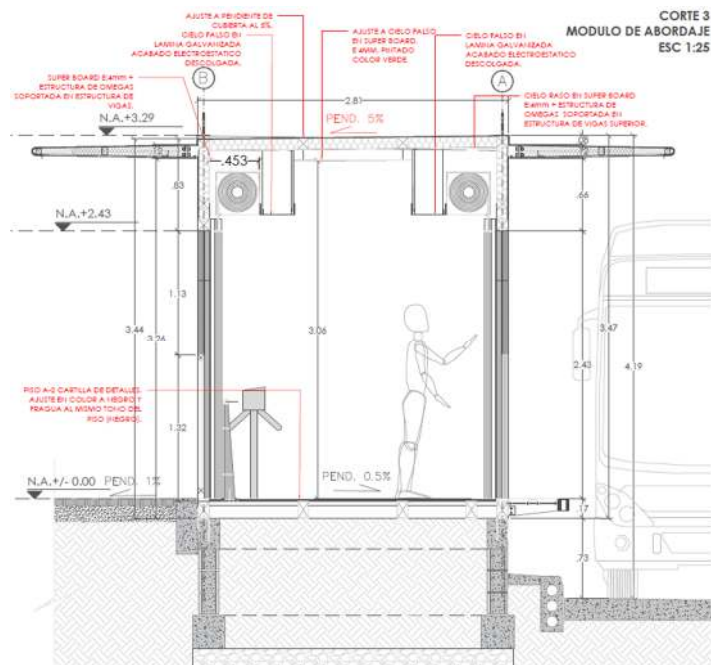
Instalación de lámina galvanizada remachada a las vigas estructurales del costado lateral. Plano 12. A-302 CORTE GENERAL 3 - 4.dwg
